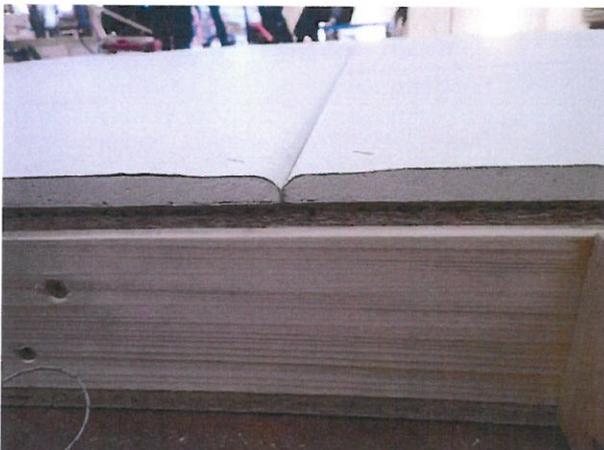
Seitenansicht der Konstruktion mit Variokante der Feuerschutzplatten.
